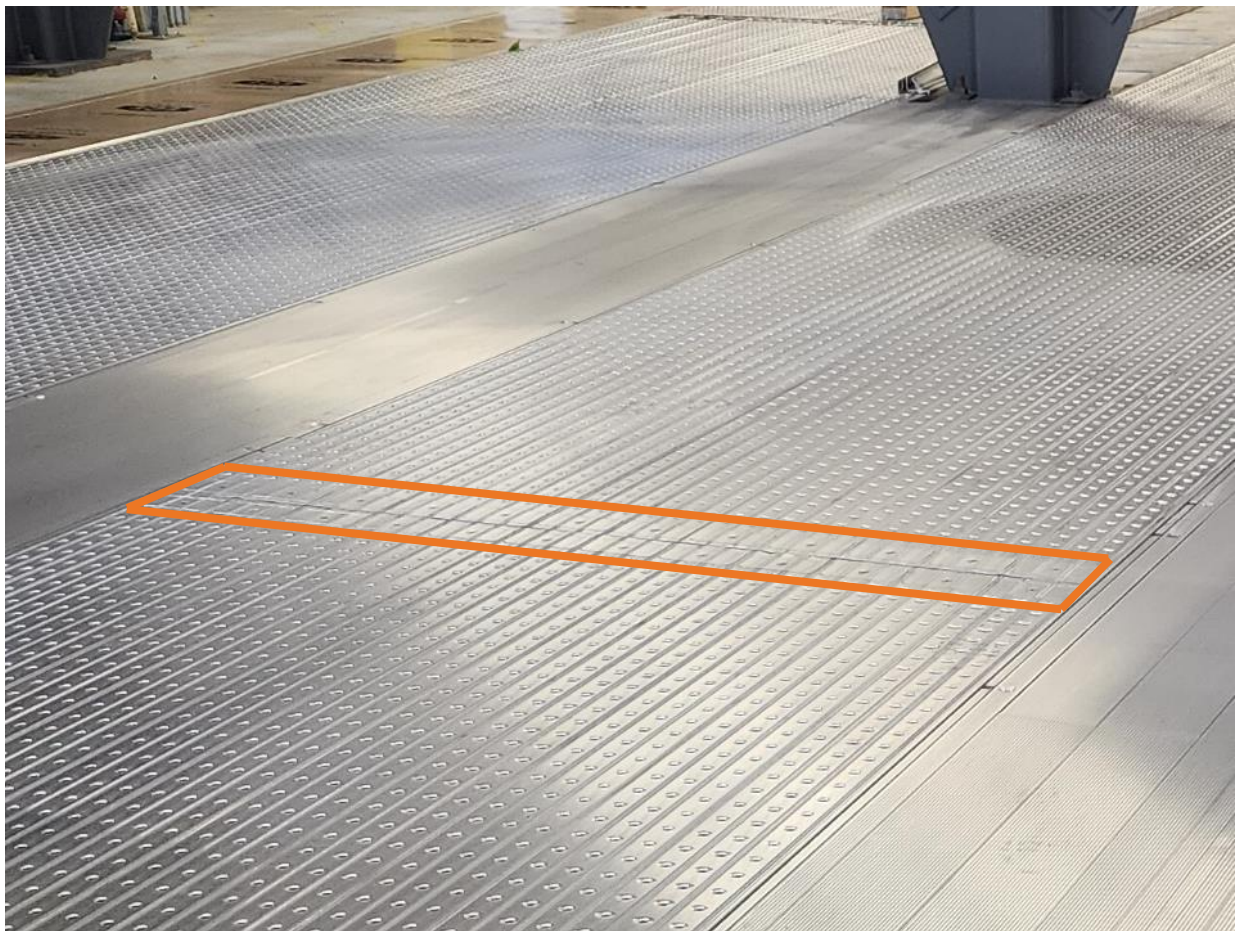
Assemblage ILDFA finalisé avec connexions bout-à-bout indiquées dans le cadre orange
